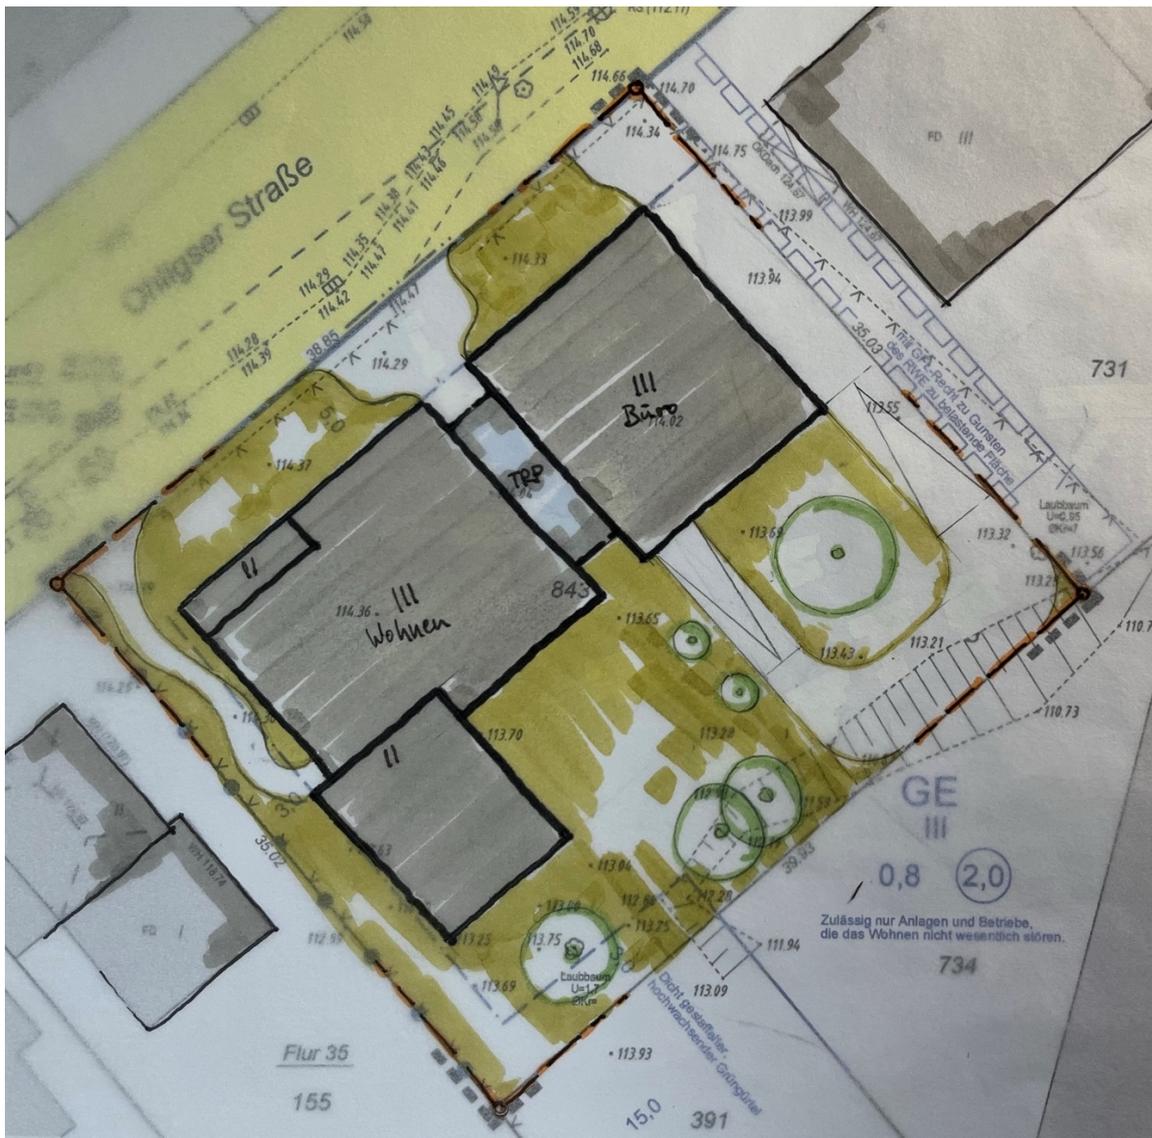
Bebauung, Variante C – zwei Baukörper mit getrennter Nutzung³
